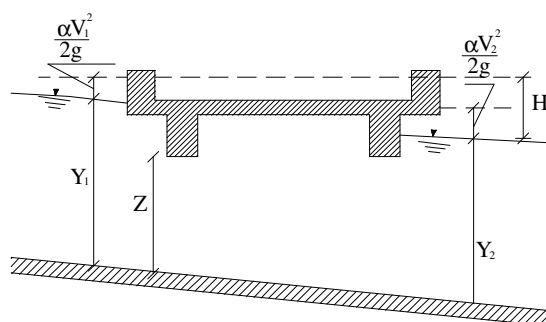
“Sezione schematica di un ponte – Schema di calcolo”
